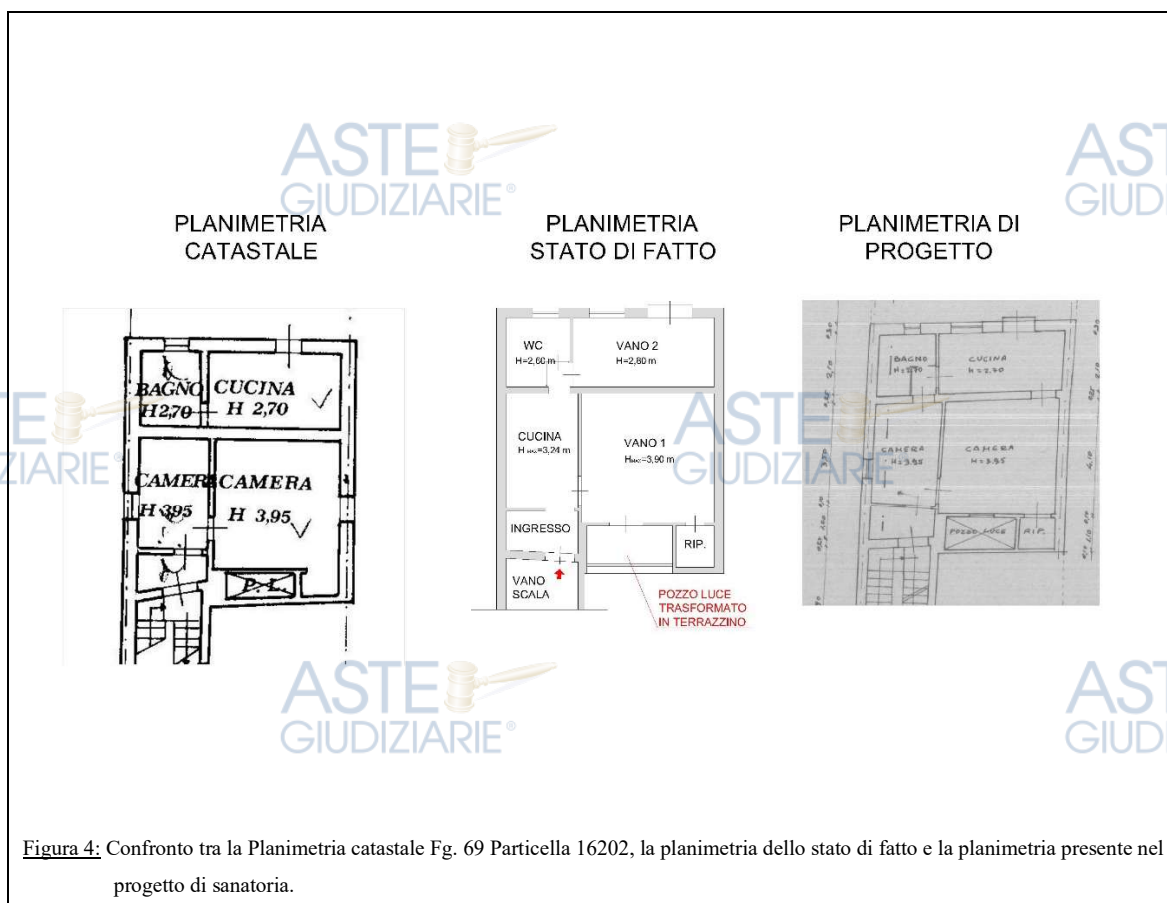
Confronto tra la Planimetria catastale Fg. 69 Particella 16202, la planimetria dello stato di fatto e la planimetria presente nel progetto di sanatoria.
